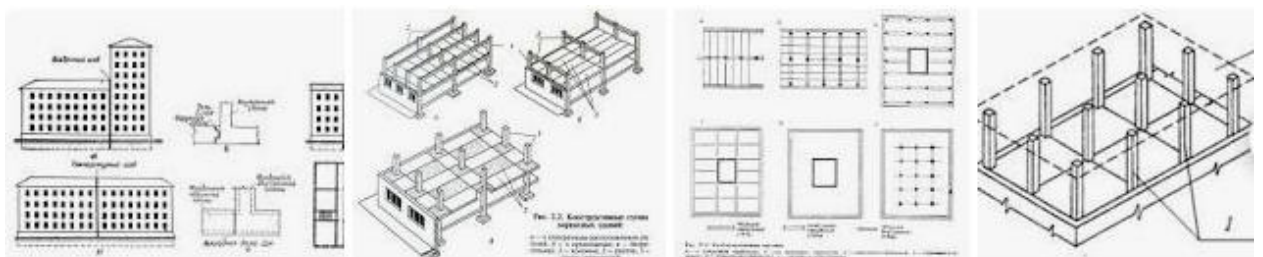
Конструктивна схема будівлі з безригельной каркасом
